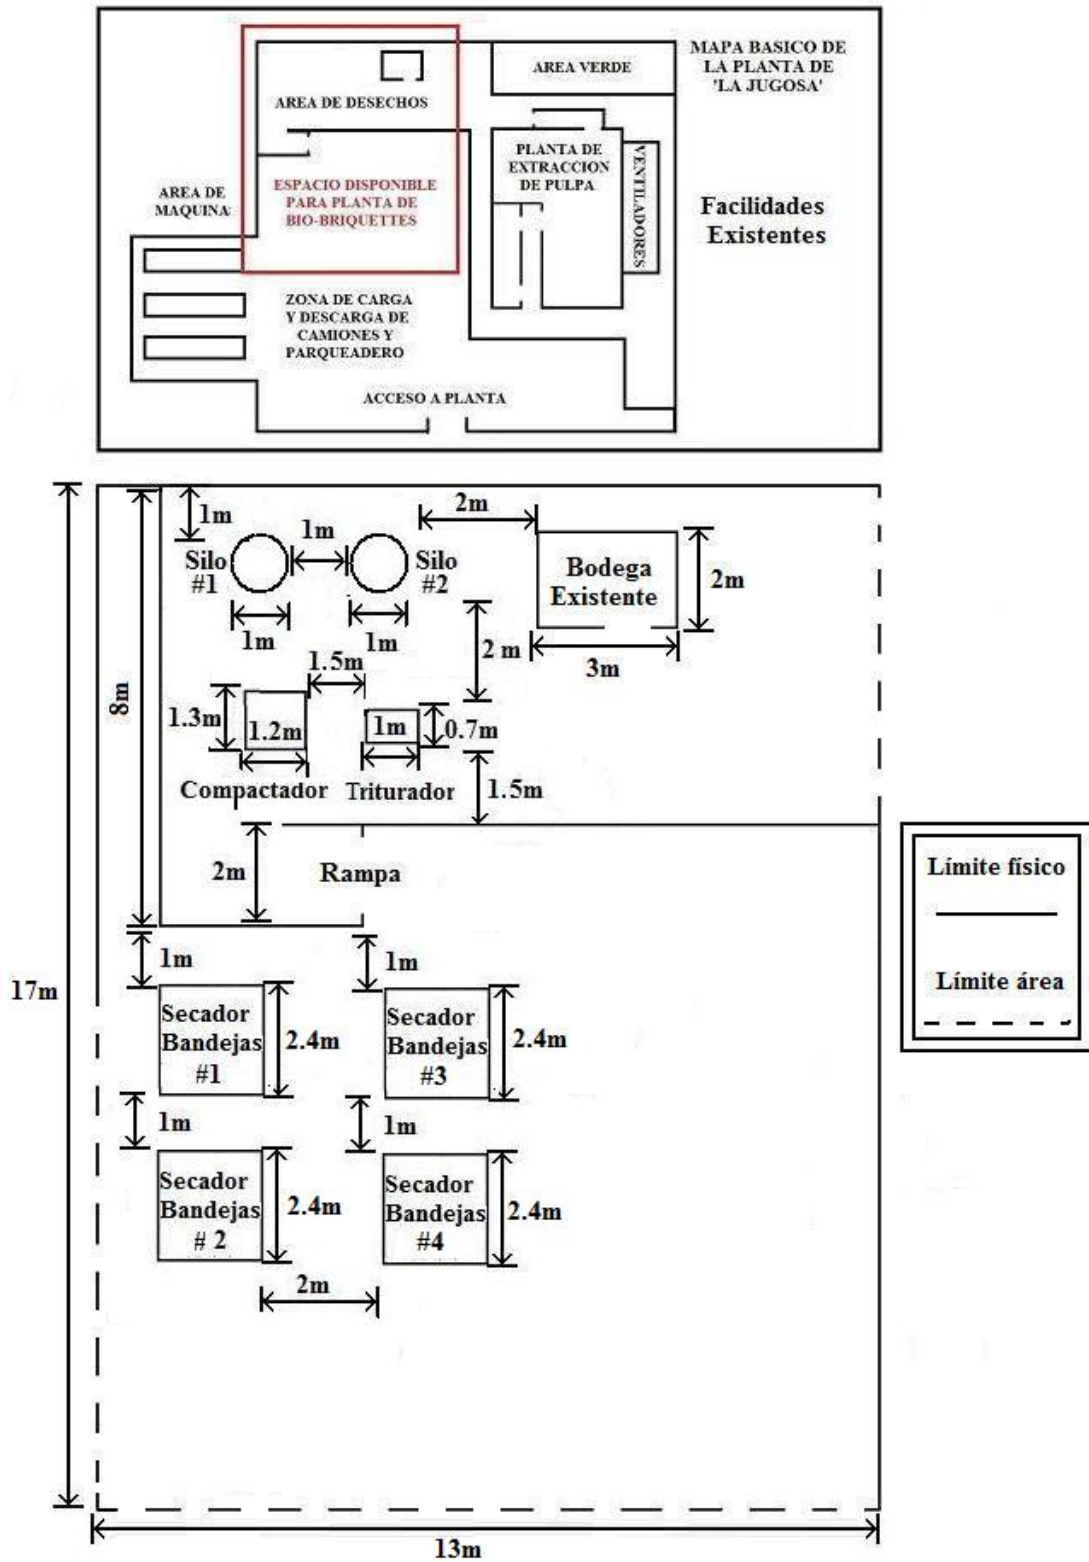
Mapa guía básico de facilidades existentes y layout propuesto de la planta de manufactura de bio-briquettes.
